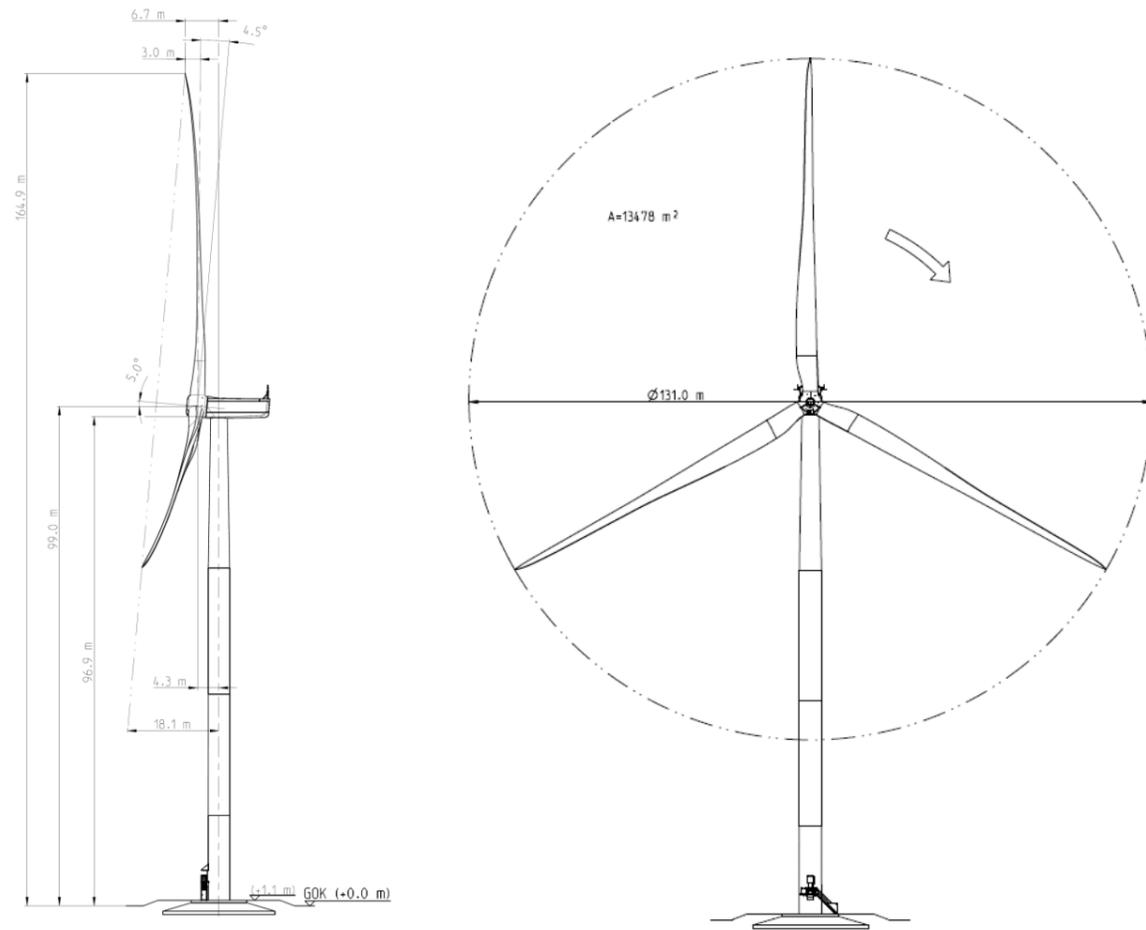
Plan d'élevation de l'éolienne N131 – 3,6 MW – 165 m (Source : NORDEX)
